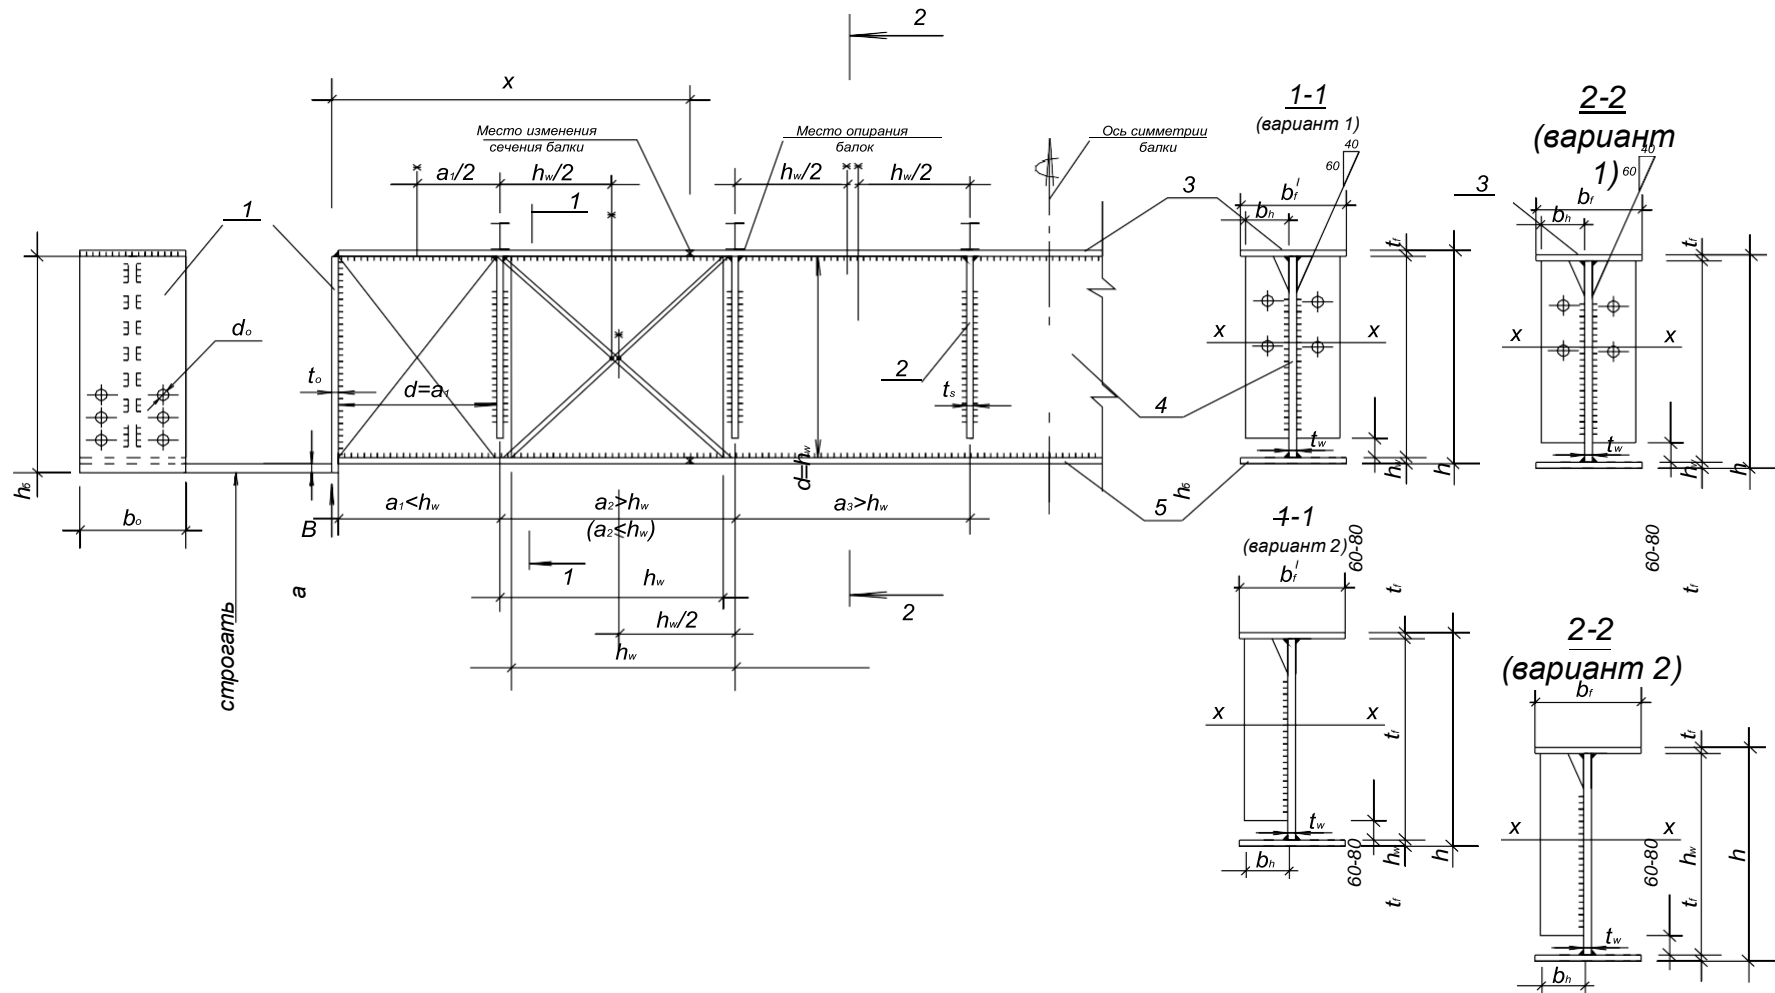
Размещение поперечных ребер под каждой опирающейся балкой в составной сварной балке ( $\sigma_{loc}=0$ ): 1 – опорное ребро; 2 – поперечные ребра жесткости; 3 – сжатый пояс балки; 4 – стенка балки; 5 – растянутый пояс балки; \* – место расположения сечения в отсеке или условном отсеке для которого вычисляются  $M$ ,  $Q$ ,  $I_x$  при проверке местной устойчивости стенки балки по формуле (6.9); † – границы условного отсека
